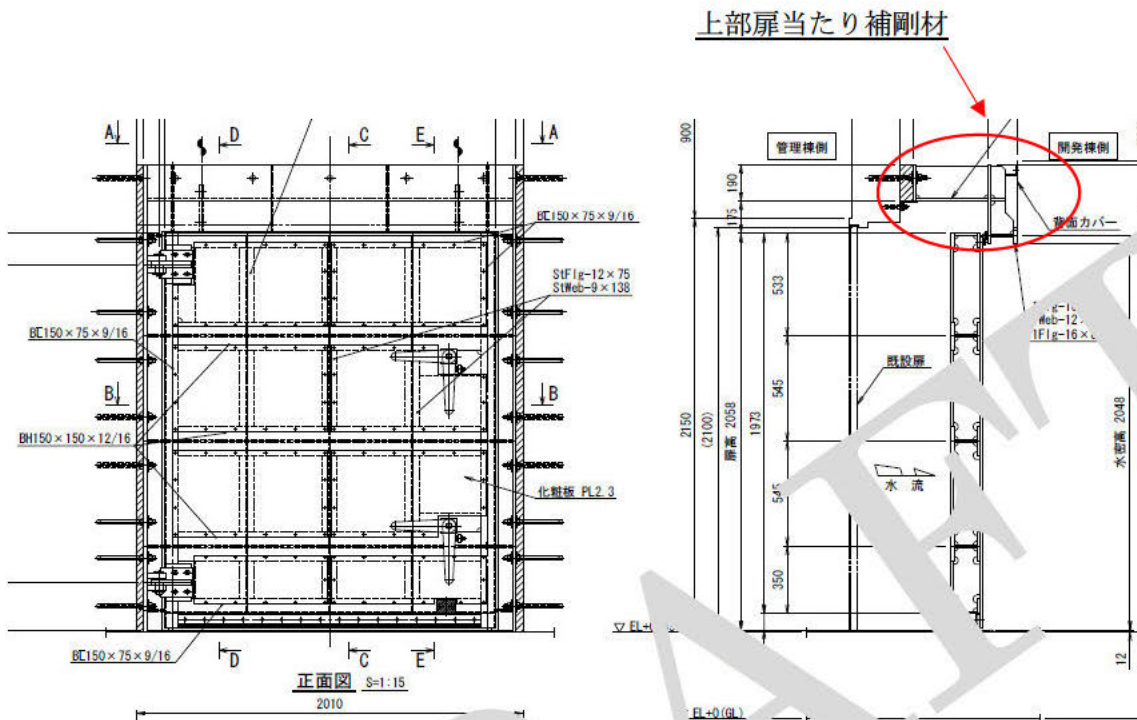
水止扉 (VF-1) の構造図 (2/2)
